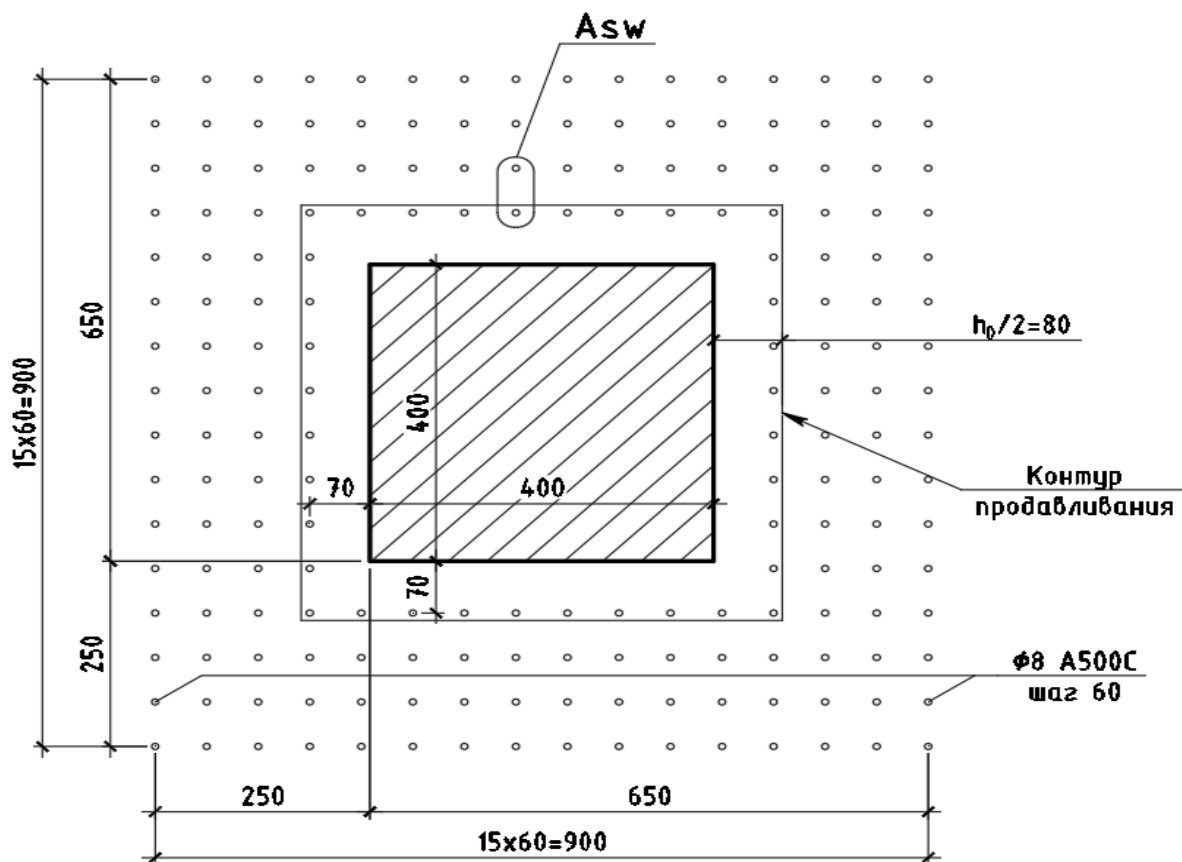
Схема для расчёта прочности плиты перекрытия на продавливание колонной квадратного сечения 400x400
